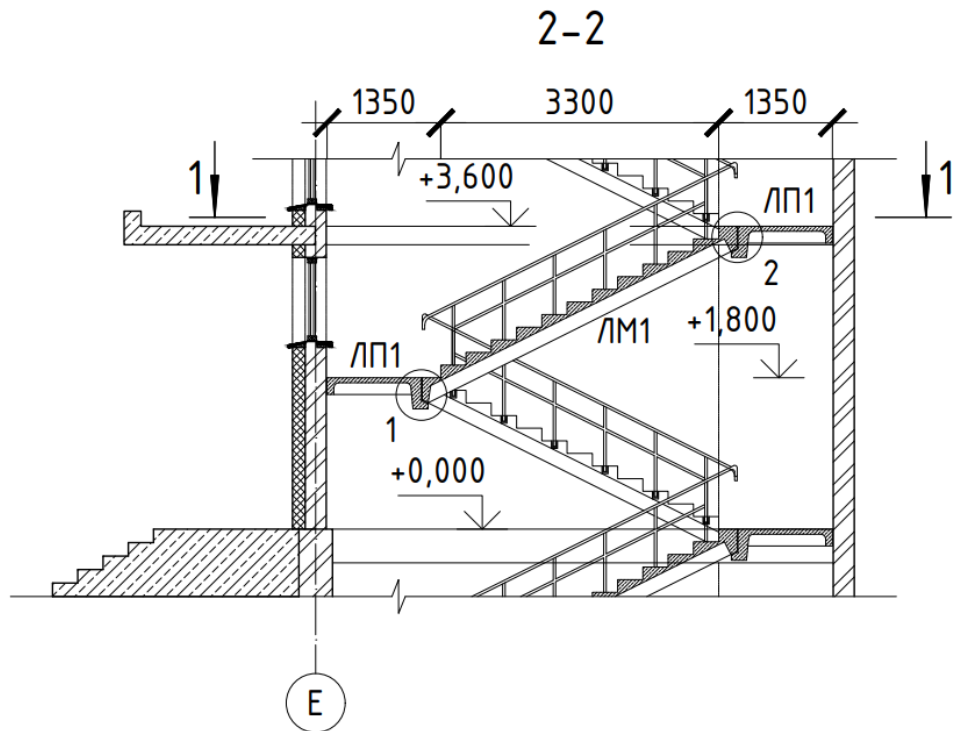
Повздовжній розріз сходів; фрагмент плану сходової клітини
